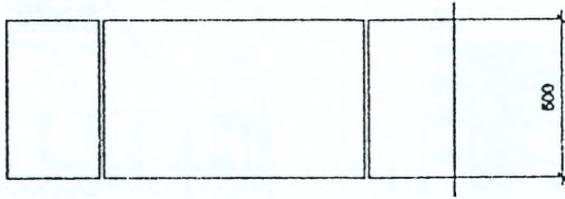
Деталь наружной несущей стены для зданий до 5-ти этажей.
